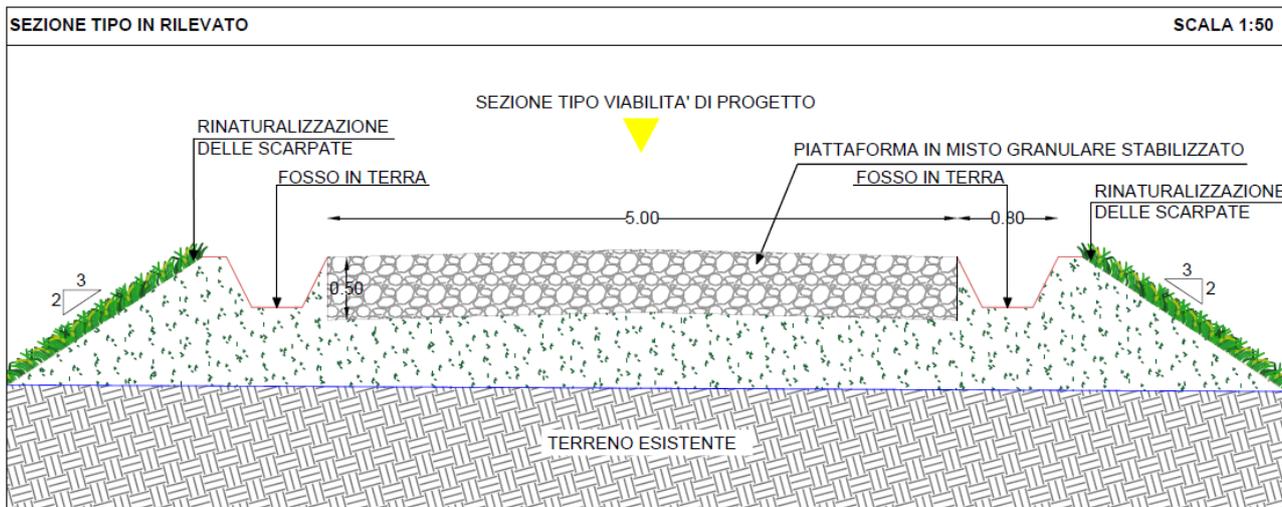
Sezione tipo in rilevato per la nuova viabilità
